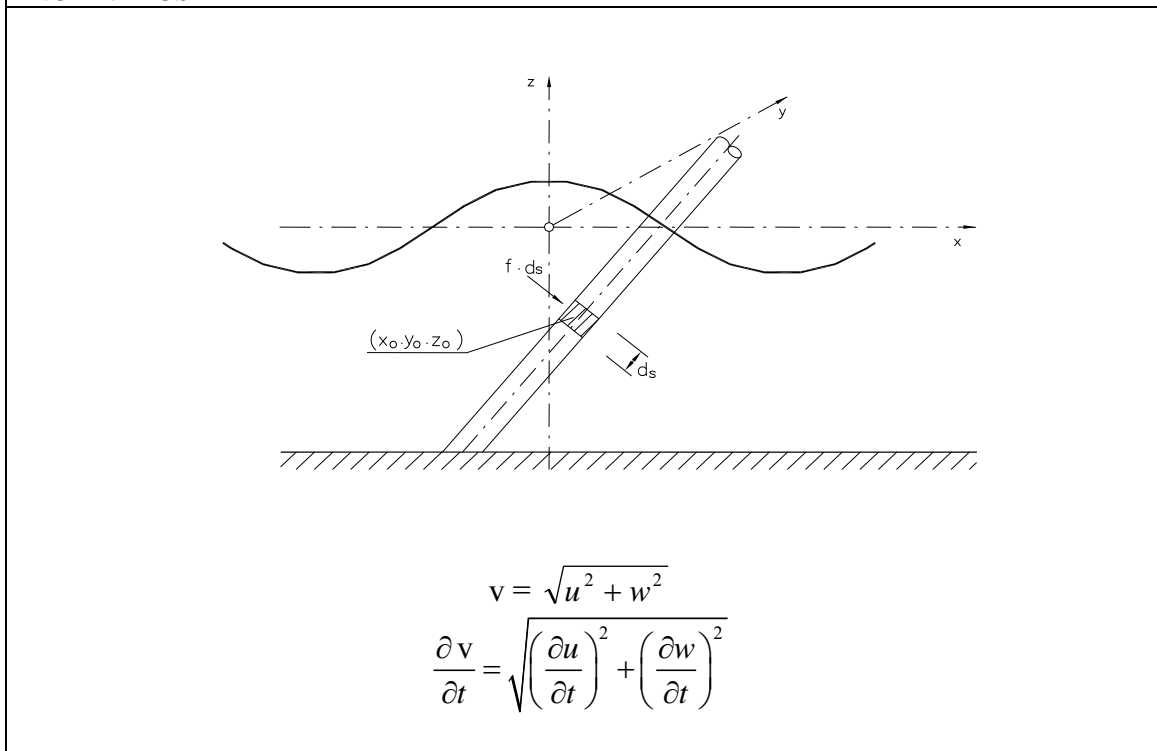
ACCIONES DEL OLEAJE SOBRE UNA PILA O UN PILOTE AISLADOS INCLINADOS
